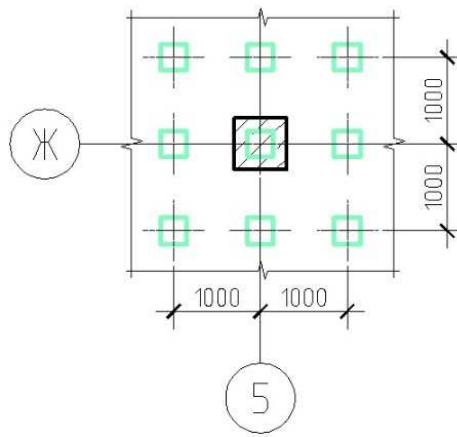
Схема расположения свай под внутреннюю стену
